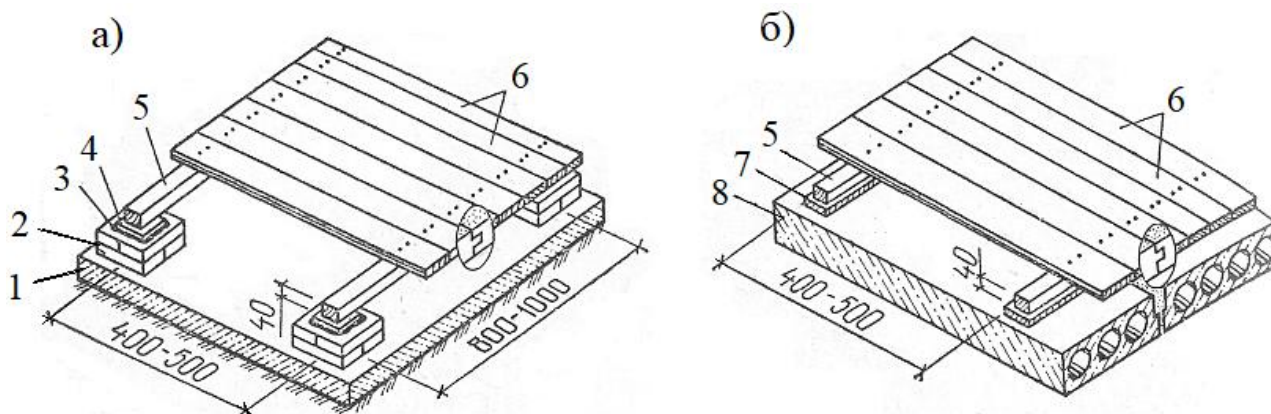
Конструктивные решения дощатых полов: а) на грунтовом основании; б) на перекрытии
